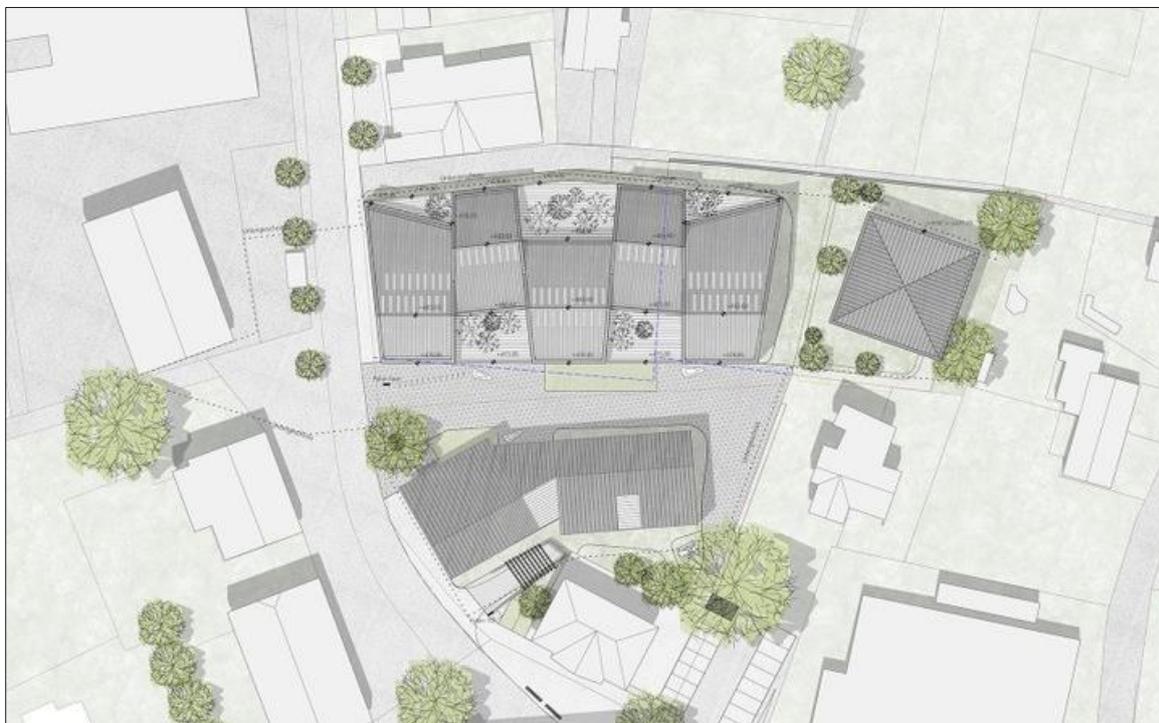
Lageplan Areal Raiba/Rauch (Böhler, 2023b)
